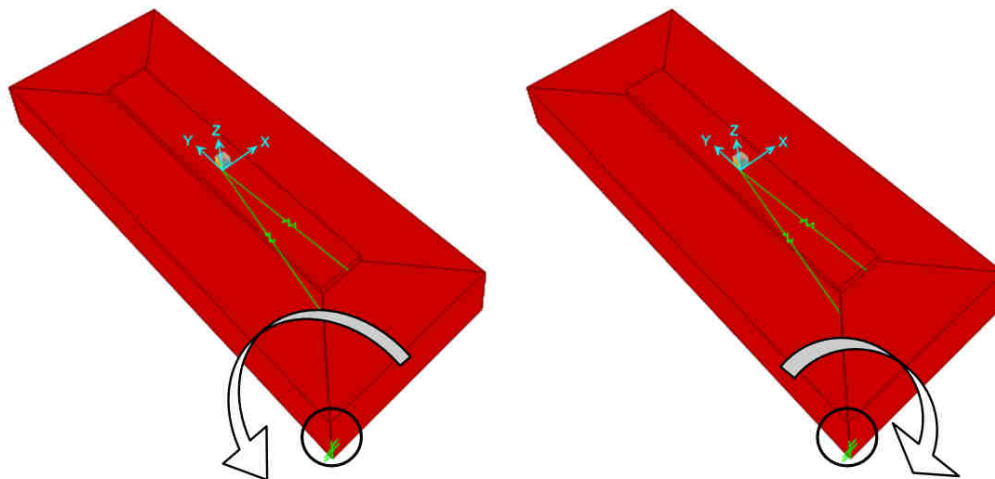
Zattera di fondazione: cinematico di ribaltamento
